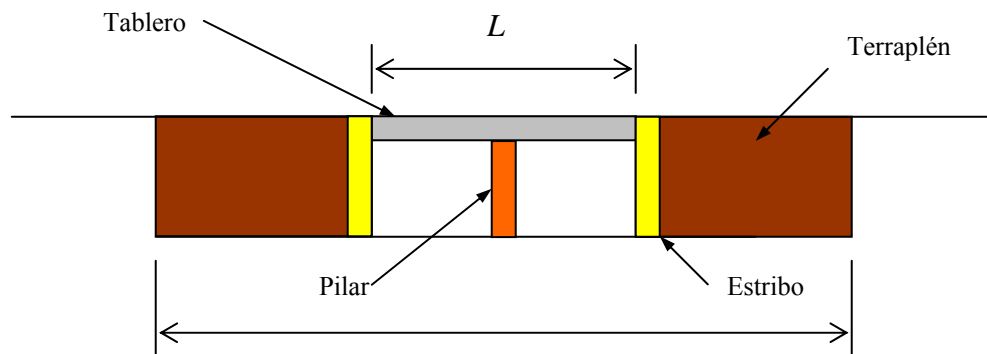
Idealización de un puente con terraplenes y pilar intermedio.
